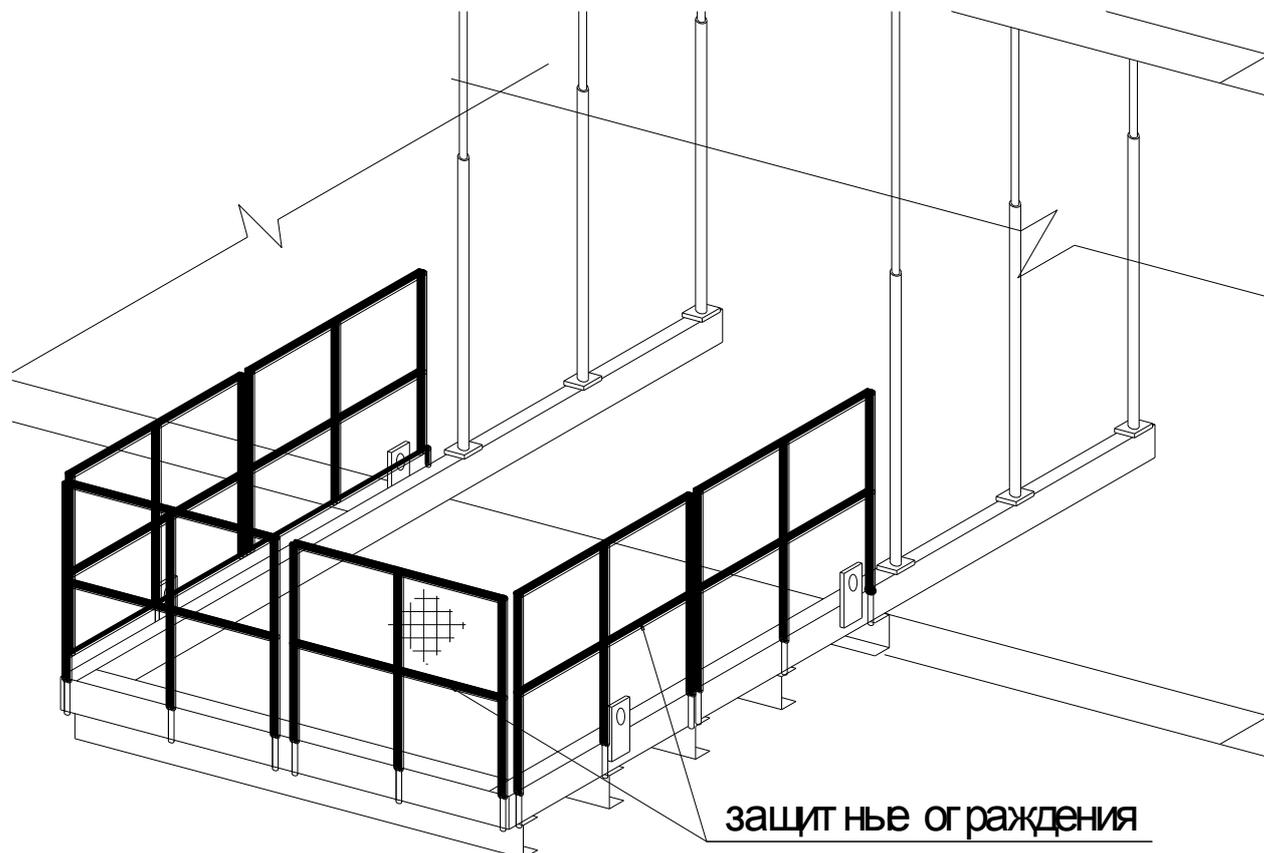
Выносная площадка для погрузо-разгрузочных работ на этаже
